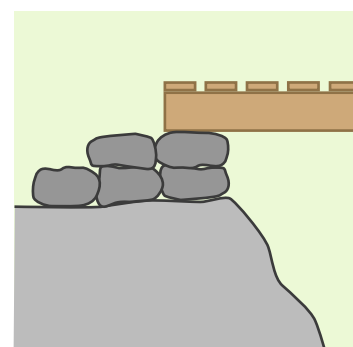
Spalla realizzata con blocchi di pietra
